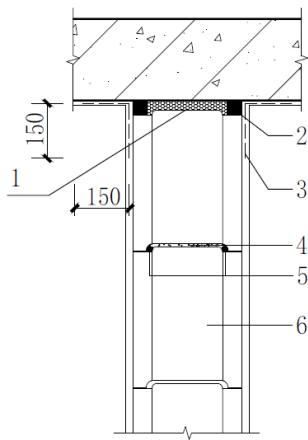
GT 高精度模块墙体与梁或顶板连接示意图（柔性连接）
